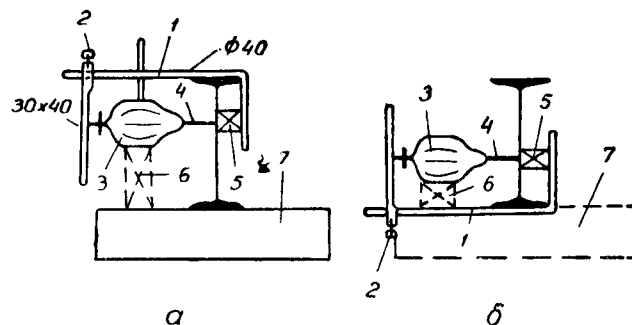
Сверление отверстий в балках переносной сверлилкой:
